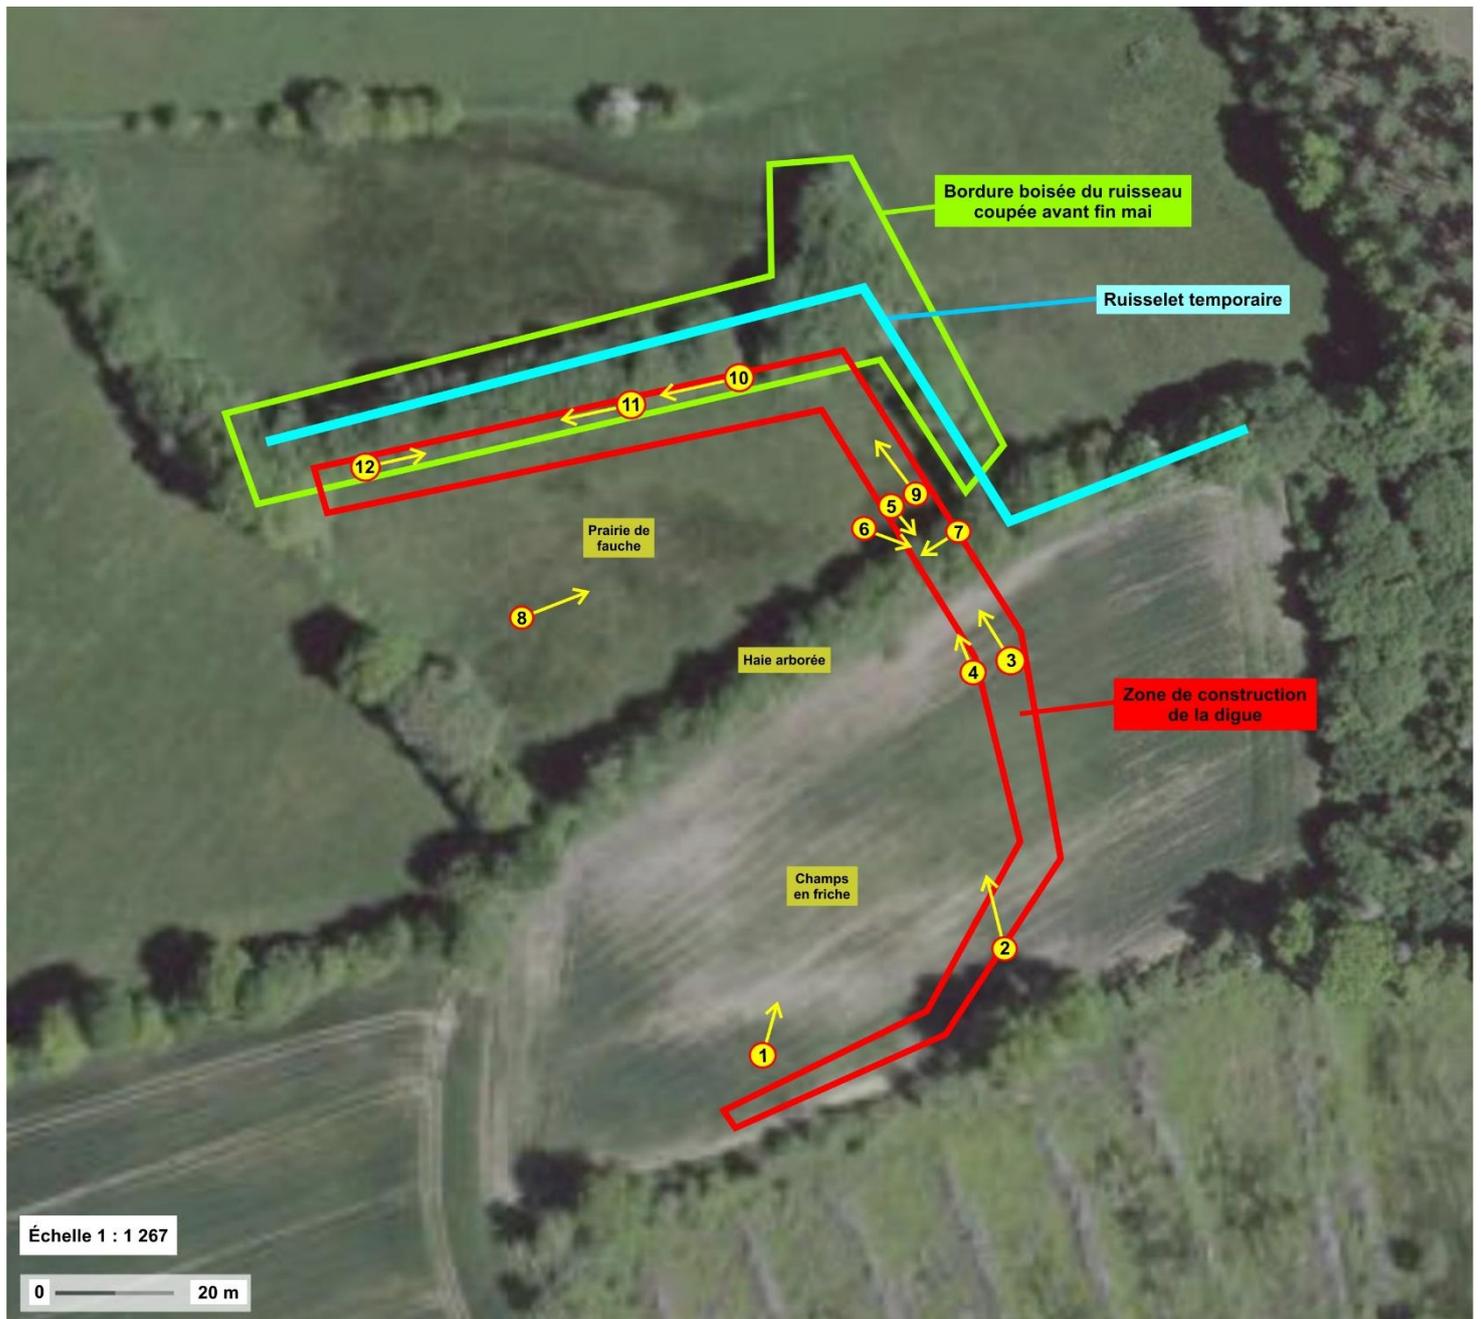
Présentation paysagère du site du bassin N° 1 (construction d'une digue, indiquée en rouge) et localisations des photographies des planches 1 et 2 (photographie de fond Géoportail).
